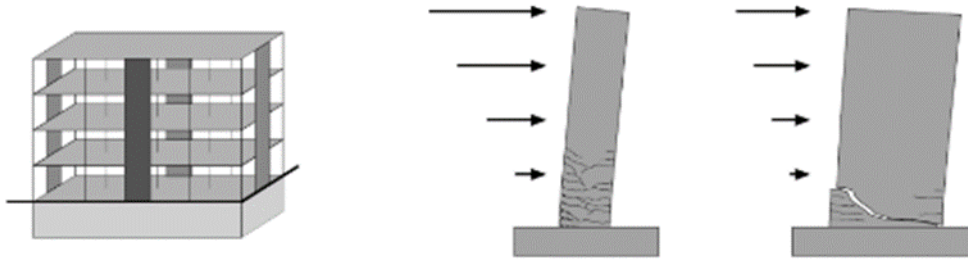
Contreventement d'un bâtiment (en béton armé). [10]
